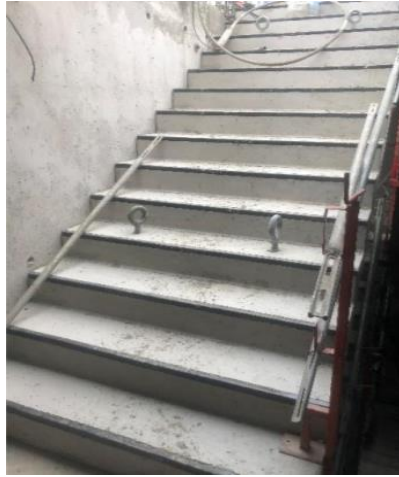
Escalera prefabricada en instalación, aún con ganchos de izaje
